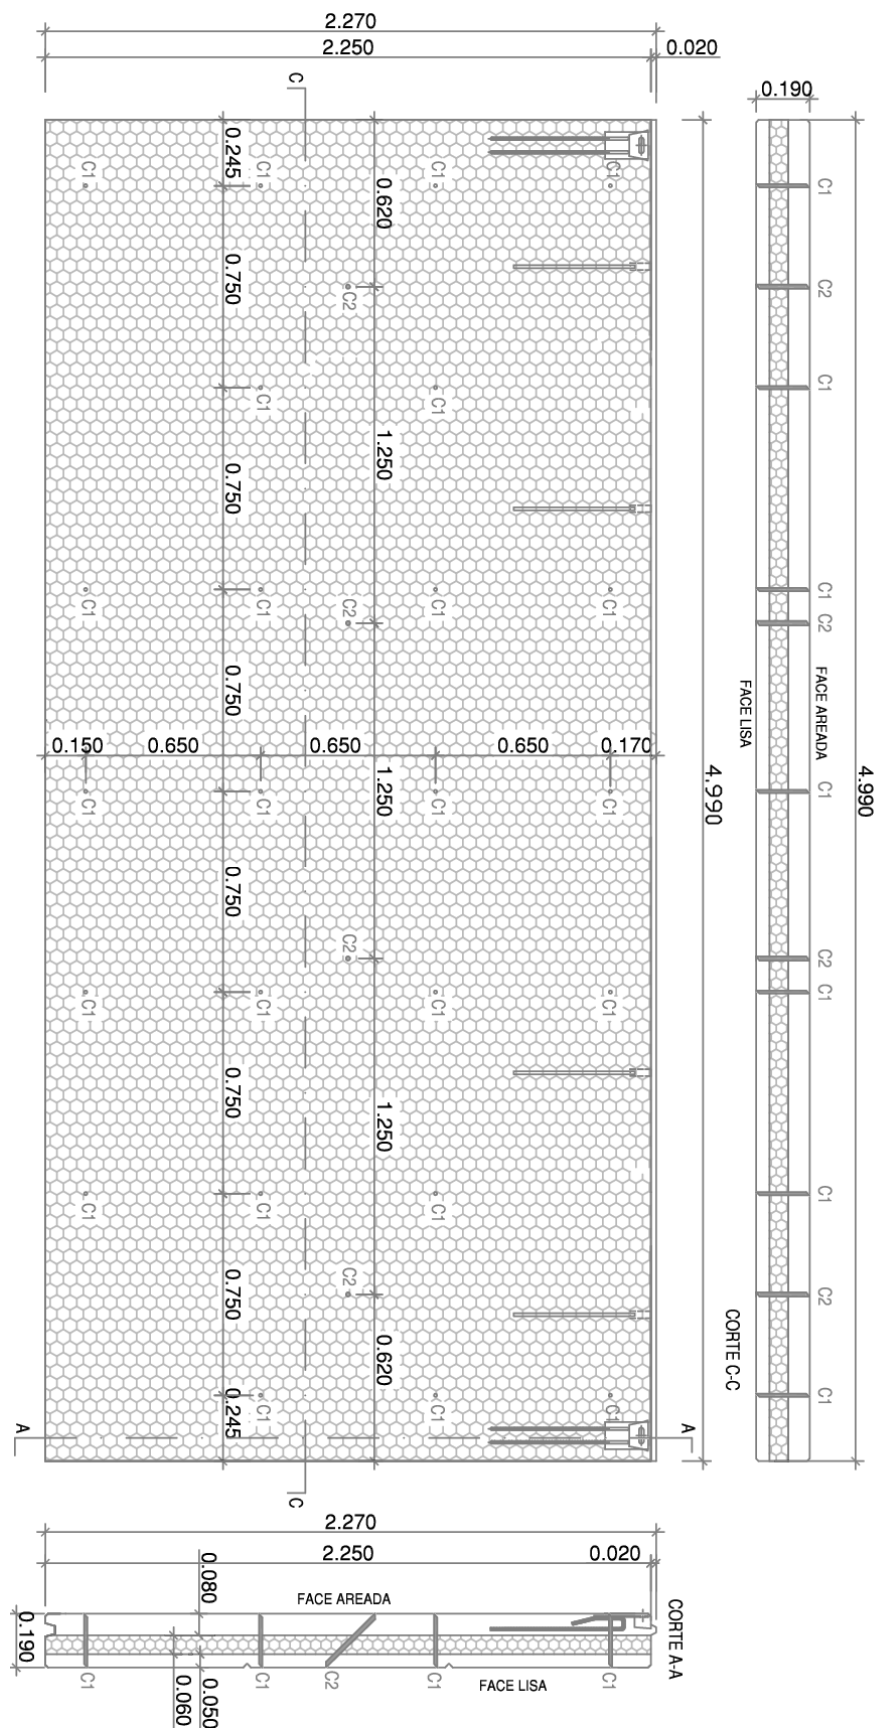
Geometria Painel com conectores em fibra de vidro e Aço (sem escala) (Adaptada de Concremat, 2011)
